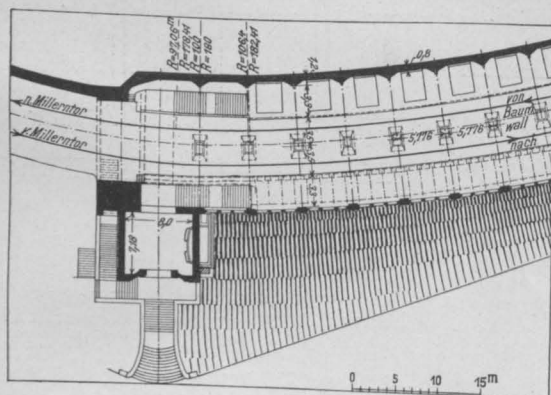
und Abb. 40. Lageplan und Teil-Grundriß Haltestelle „Landungs-Brücken“.
